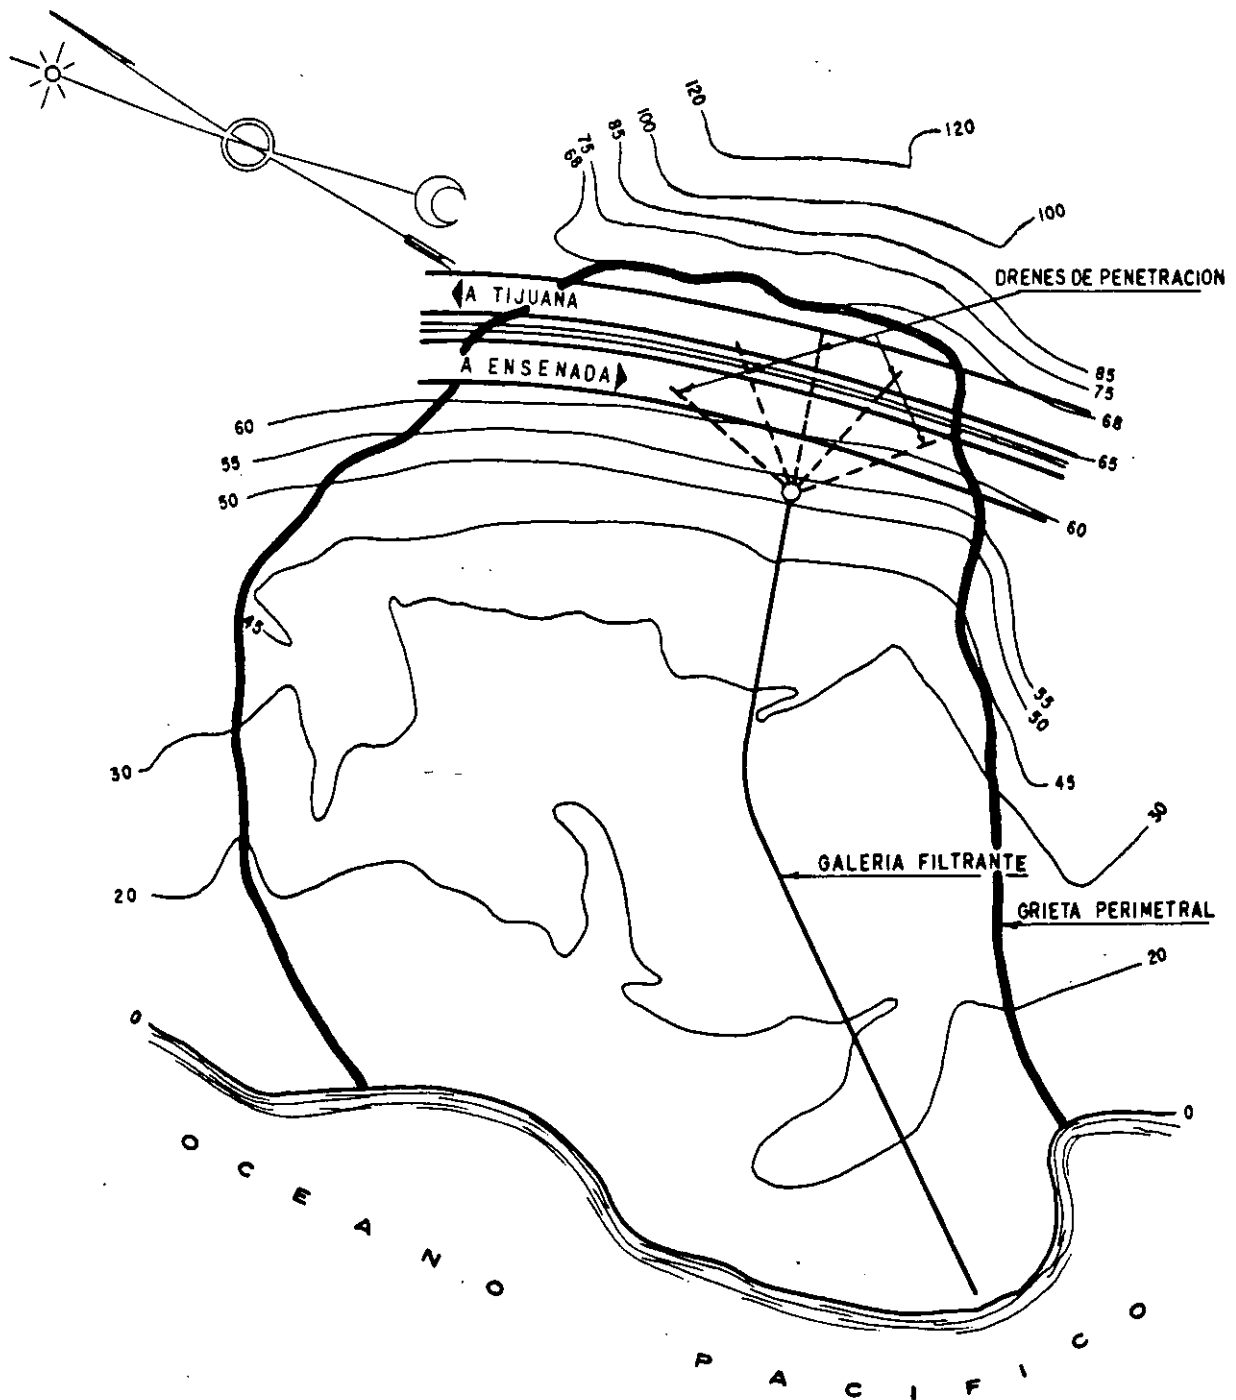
Planta de la galería filtrante construida en el km 19 + 200 de la autopista Tijuana-Ensenada (Ref. 30).
